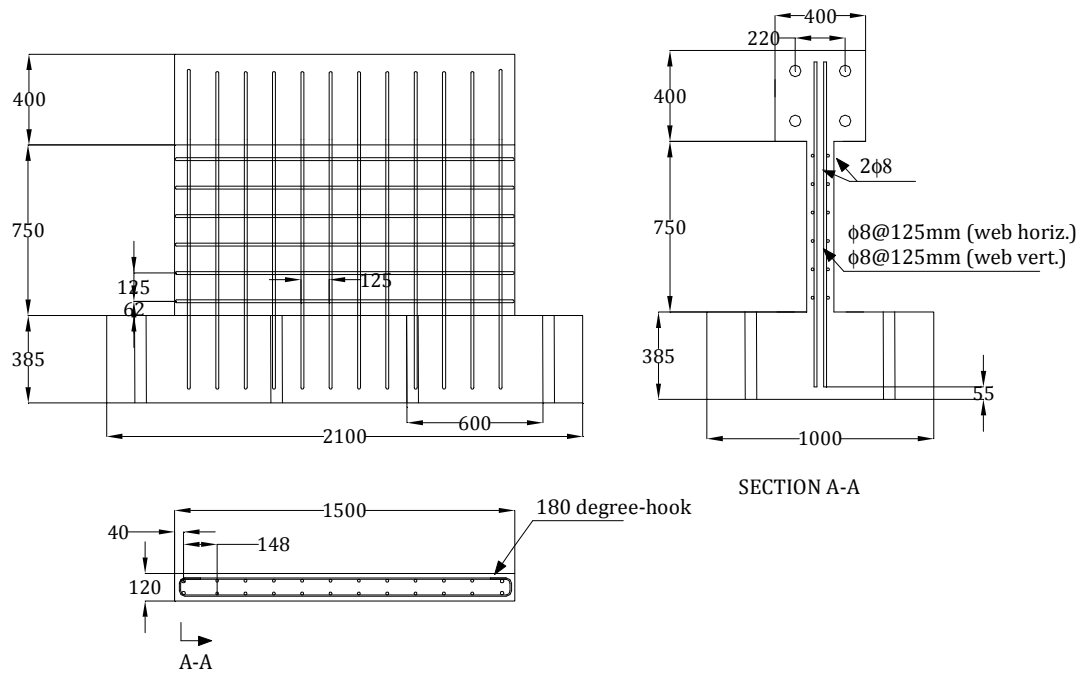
Geometría y detalle de armadura de muro Tipo 3
